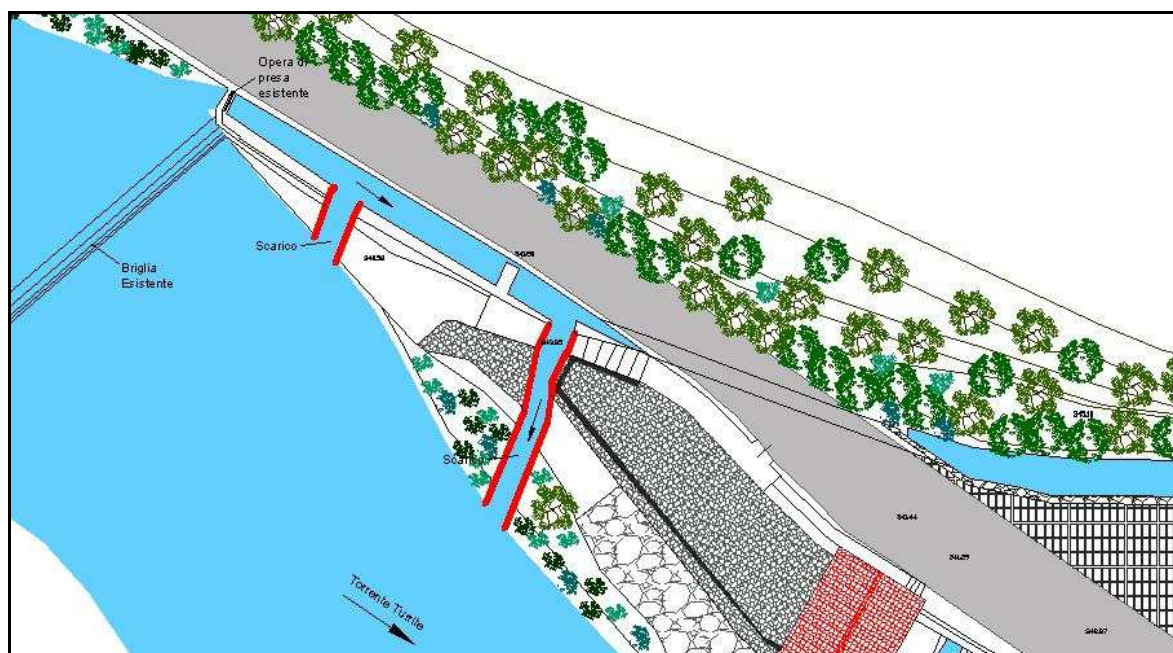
stralcio planimetrico zona opera di presa e canale di adduzione
